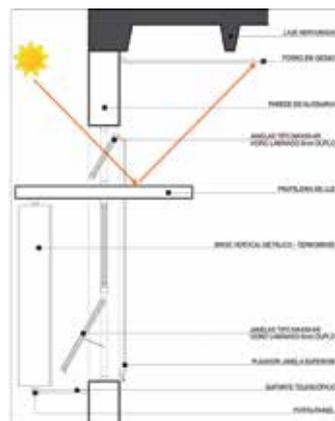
Planta baixa mostrando estudo da técnica PSALI. Fonte: Planta baixa realizada pela acadêmica
